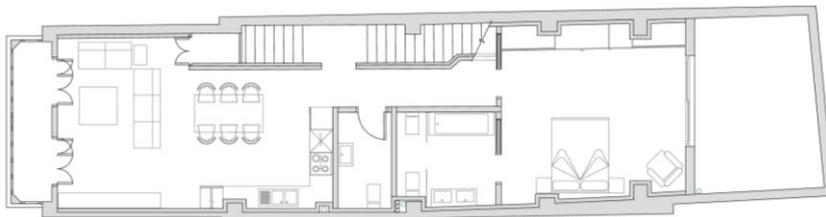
Distribución estancias planta primera. 2018. Fuente: Propia
